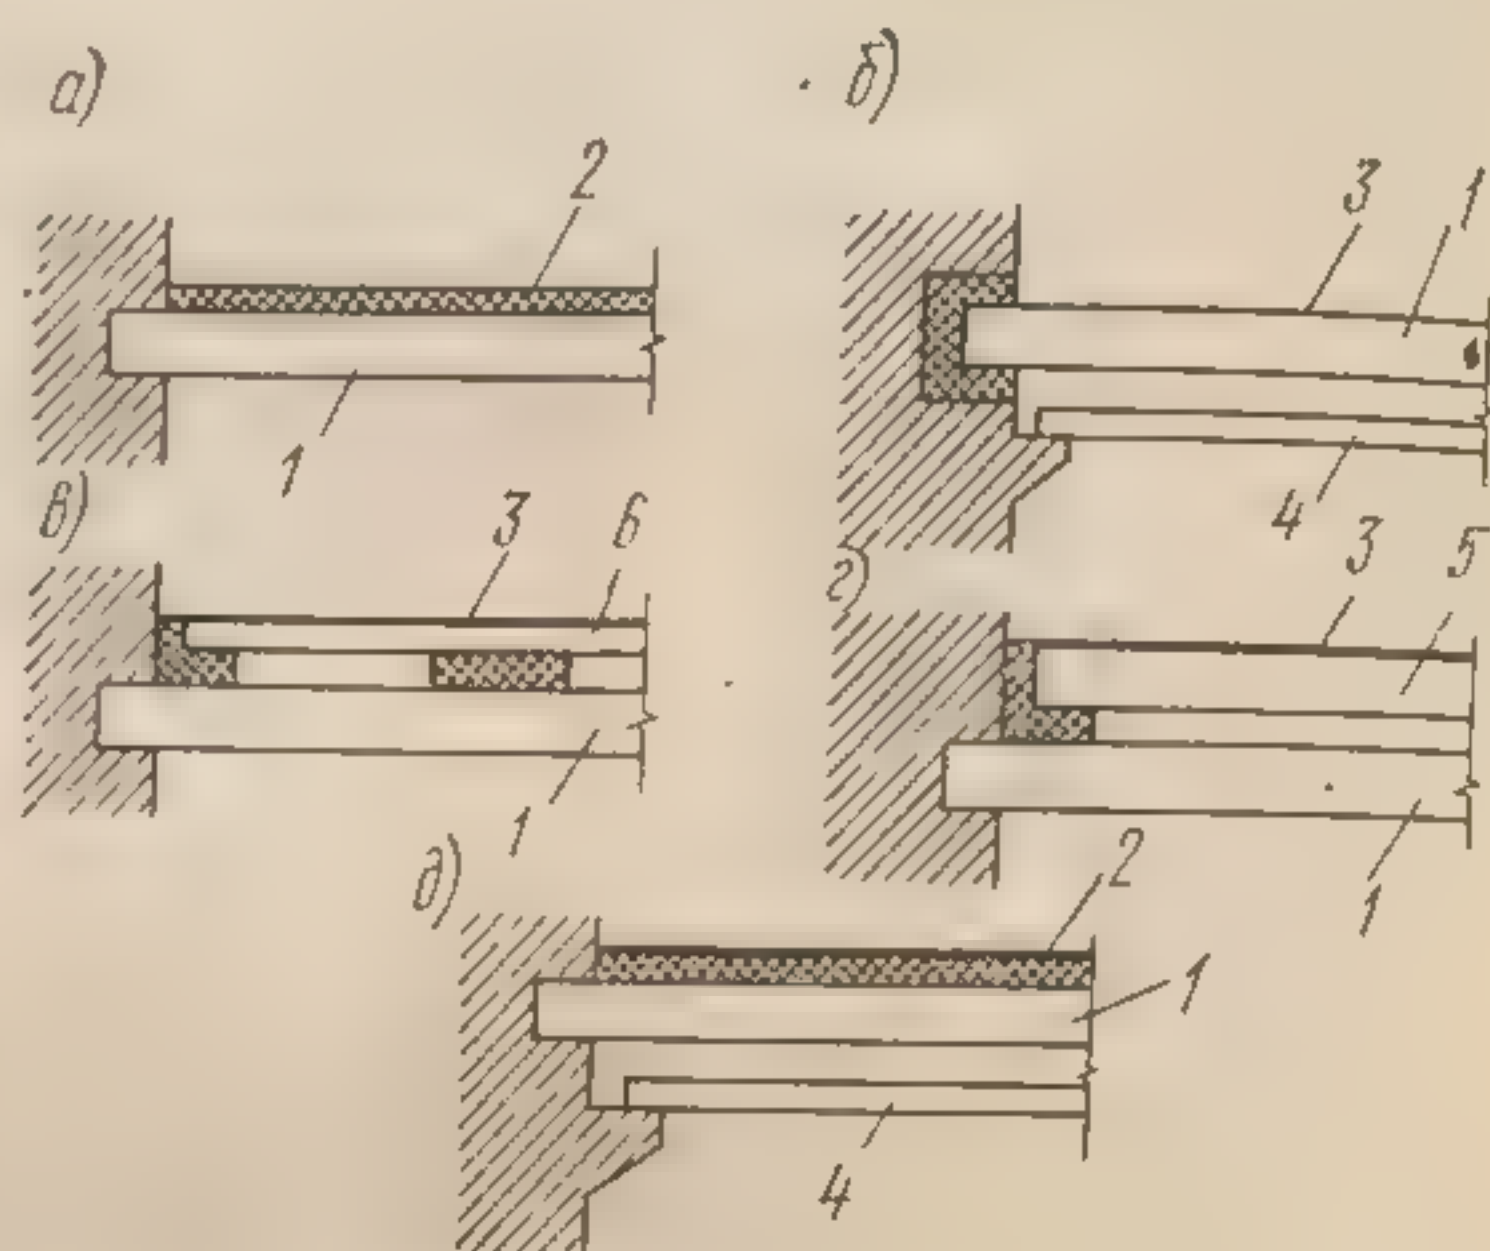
Конструктивные схемы железобетонных междуэтажных панельных перекрытий:
